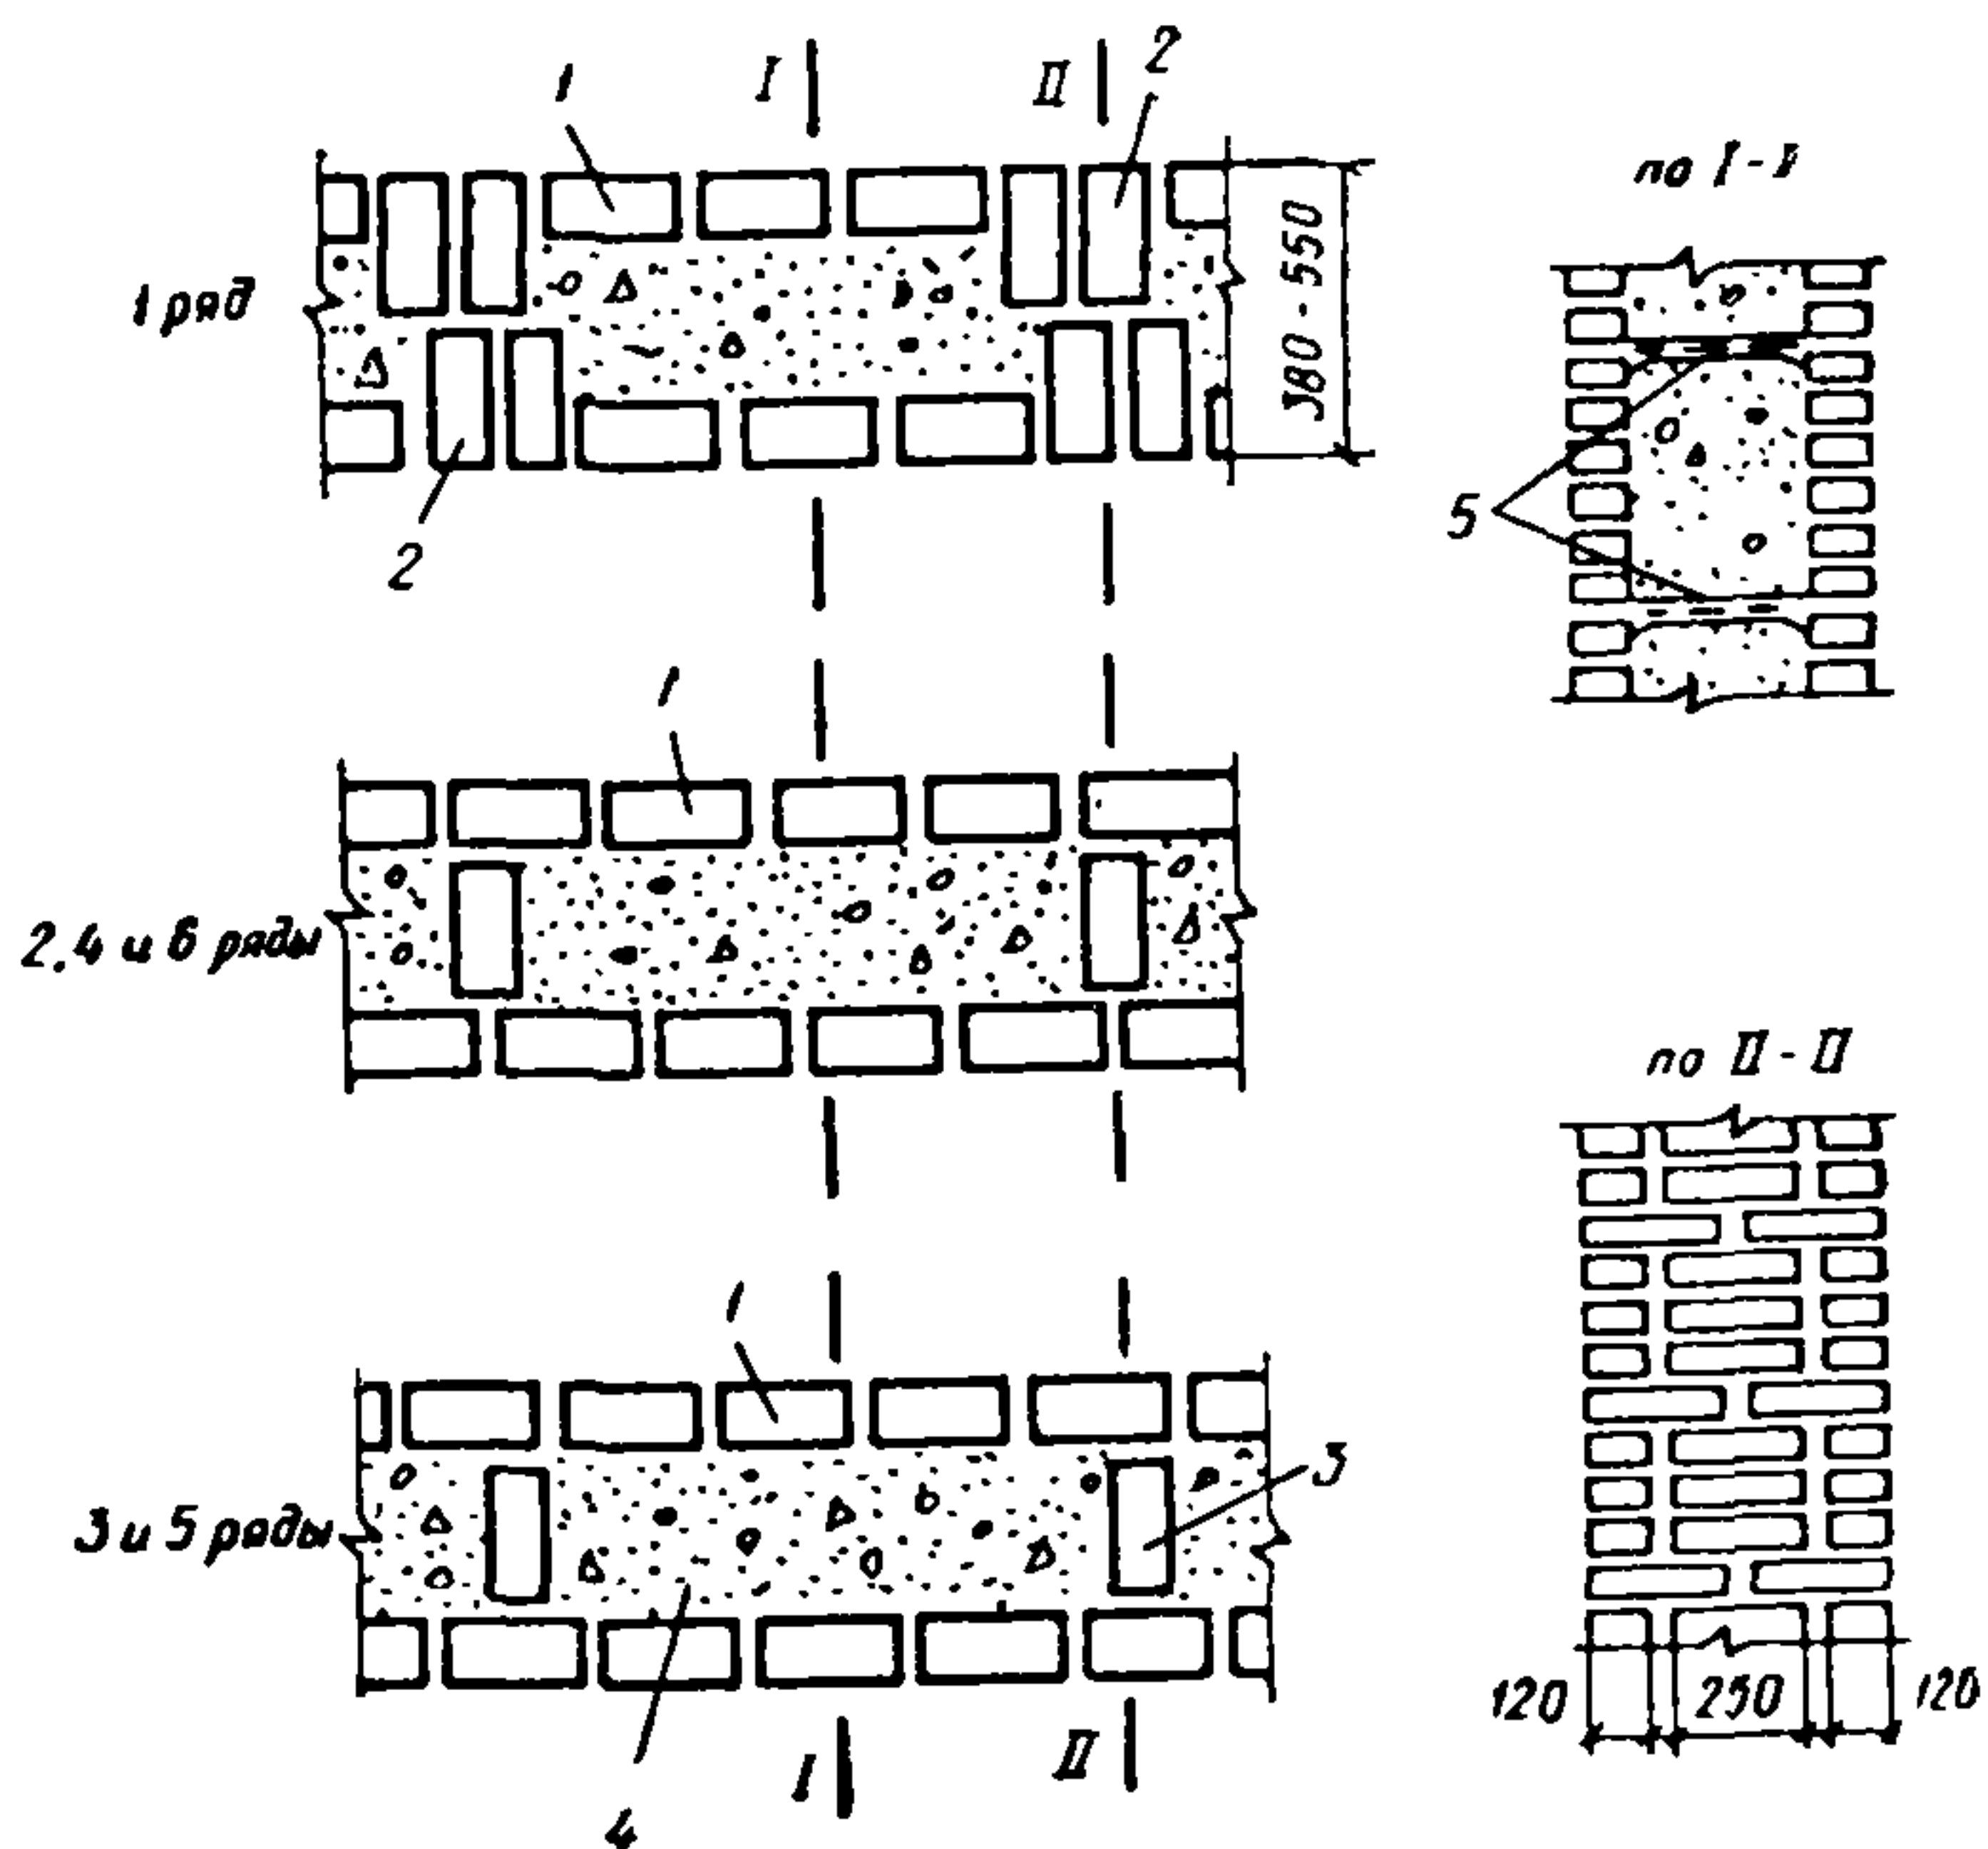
Кладка типа VIIб с вертикальными поперечными стенками с многорядной перевязкой
